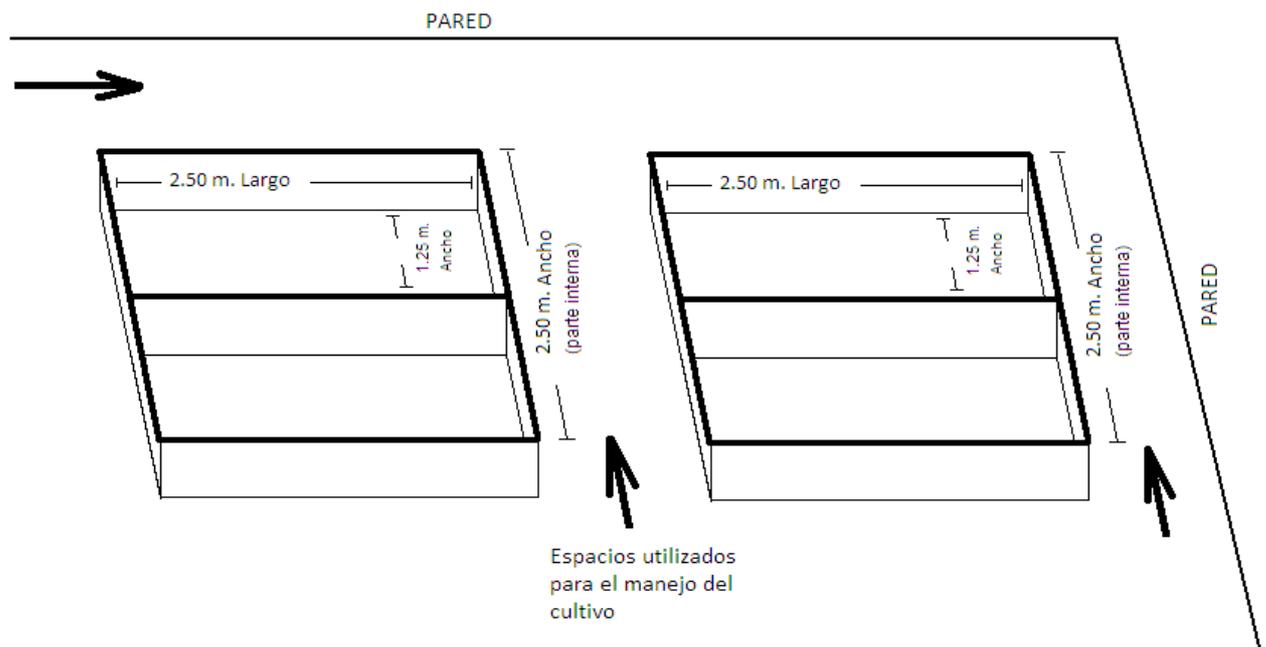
Esquema estructural de las piscinas. Fuente: Propia autoría
